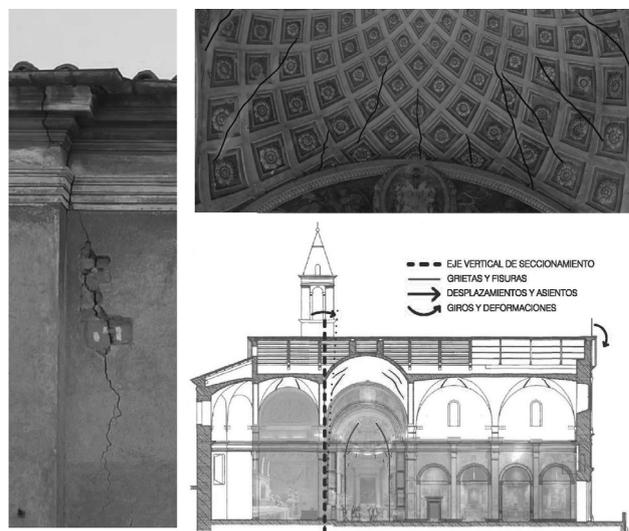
Fotografías, exterior e interior, y esquema conceptual del plano vertical de seccionamiento
